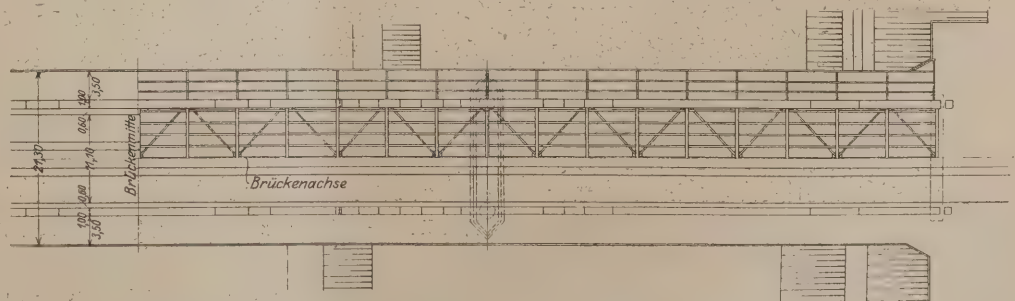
Grundriß; oben Fahrbahntafel mit Windverband, unten Aufsicht.
